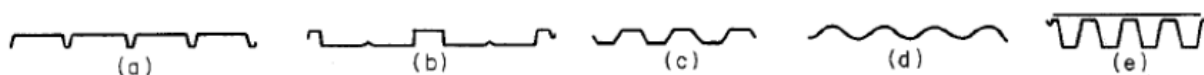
Painéis de chapa e chapas perfiladas de aço enformado a frio (Yu & Laboube, 2010).
